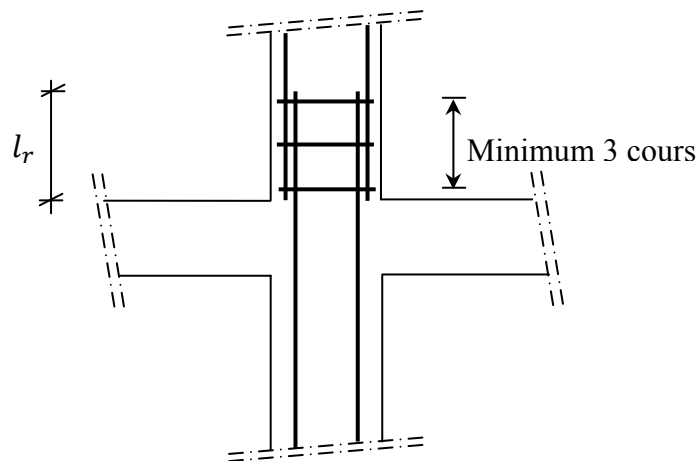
Les armatures transversales dans la zone de recouvrement
